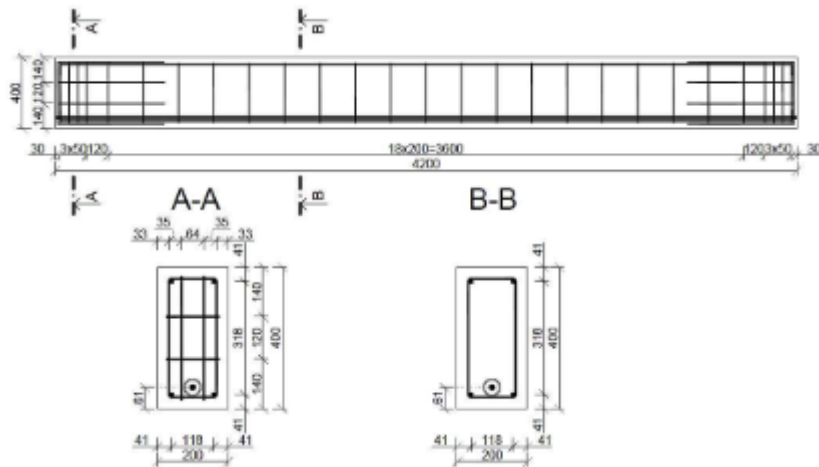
Esquema de armado activo y pasivo del elemento. Cotas en mm. (Fuente: Kralovanec et al., 2021).
